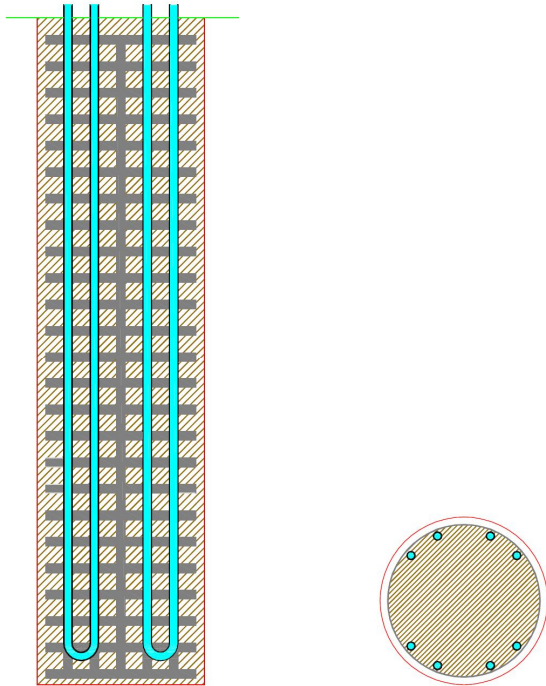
Pianta dall'alto e sezione di un palo energetico. Si notano la gabbia metallica e la disposizione delle tubazioni in polietilene di diametro 25 mm.
